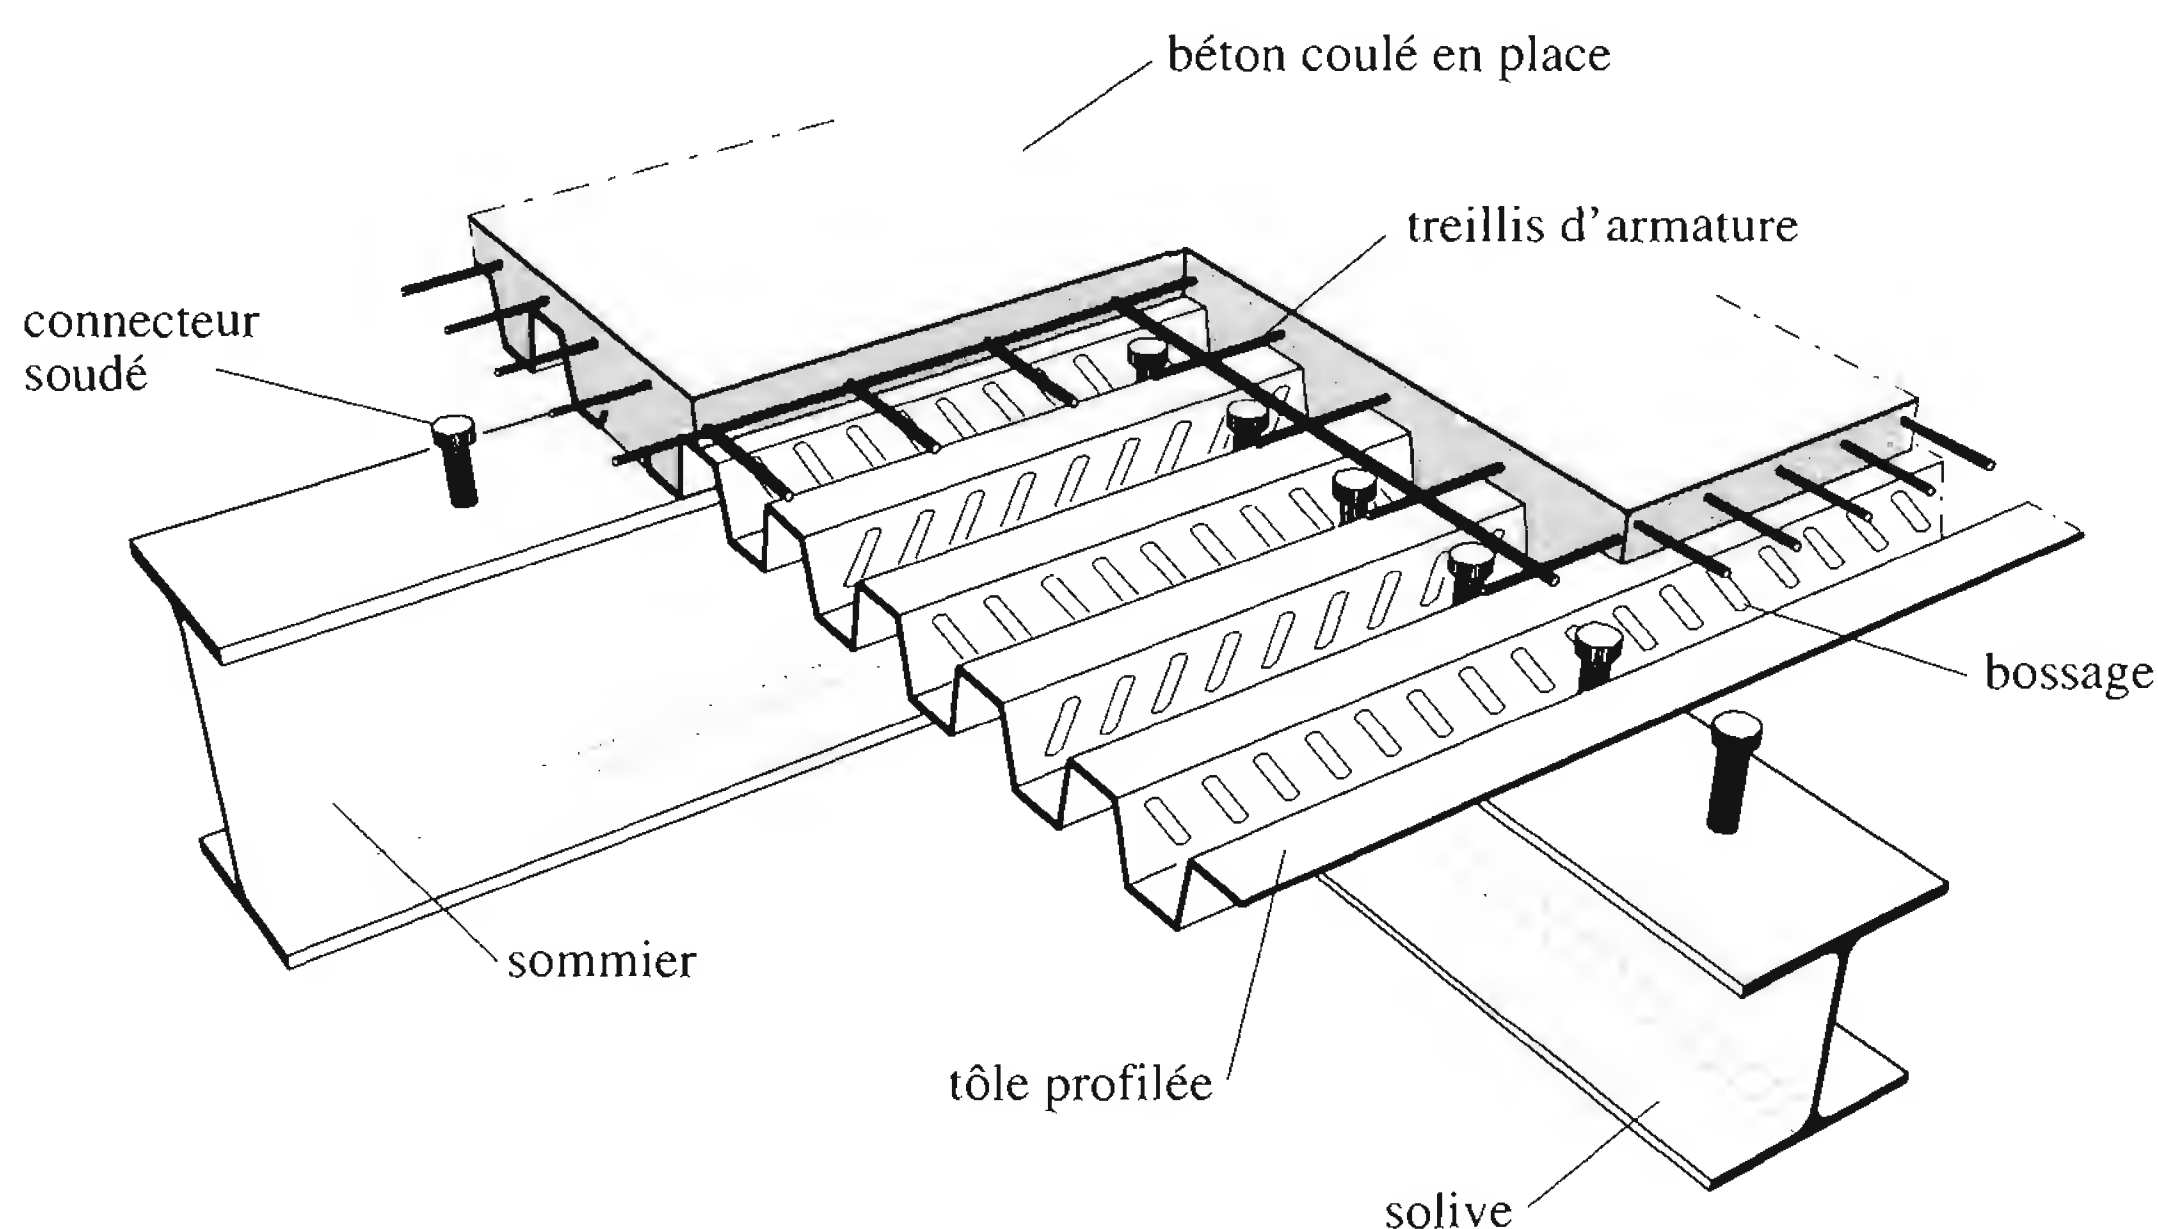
Plancher mixte avec connecteurs acier-béton.
